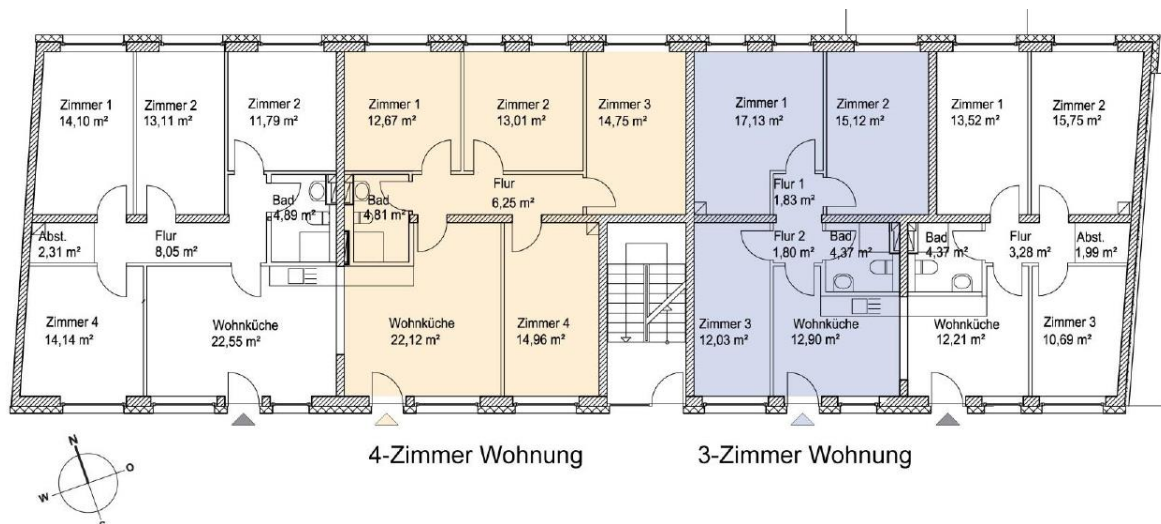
Grundriss im 2.OG des LVV-Gebäudes [1].
